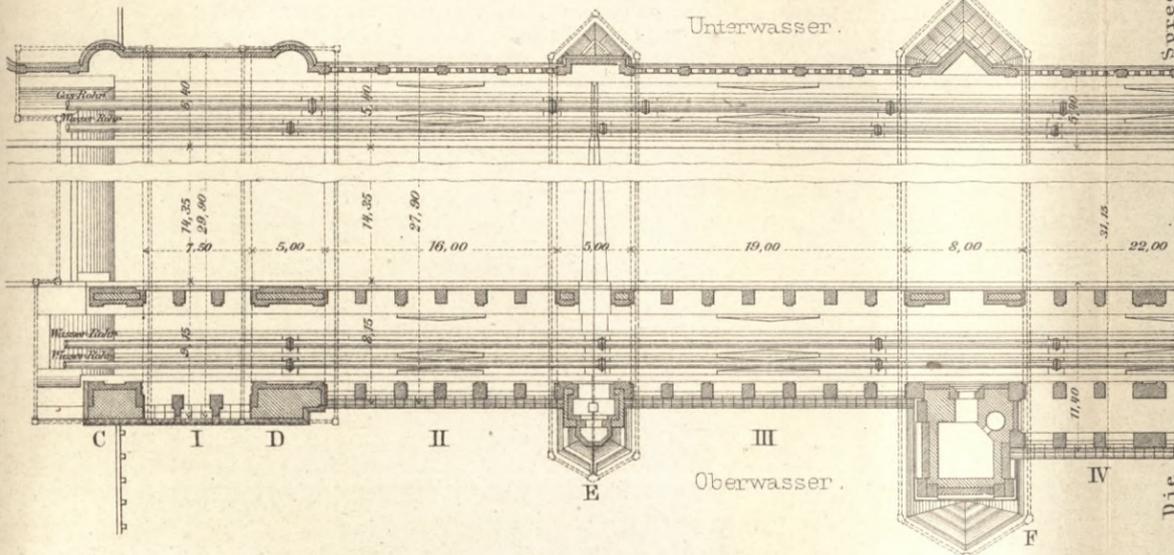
Lange Brücke in Köpenick. Längsschnitt. M.1:300.
